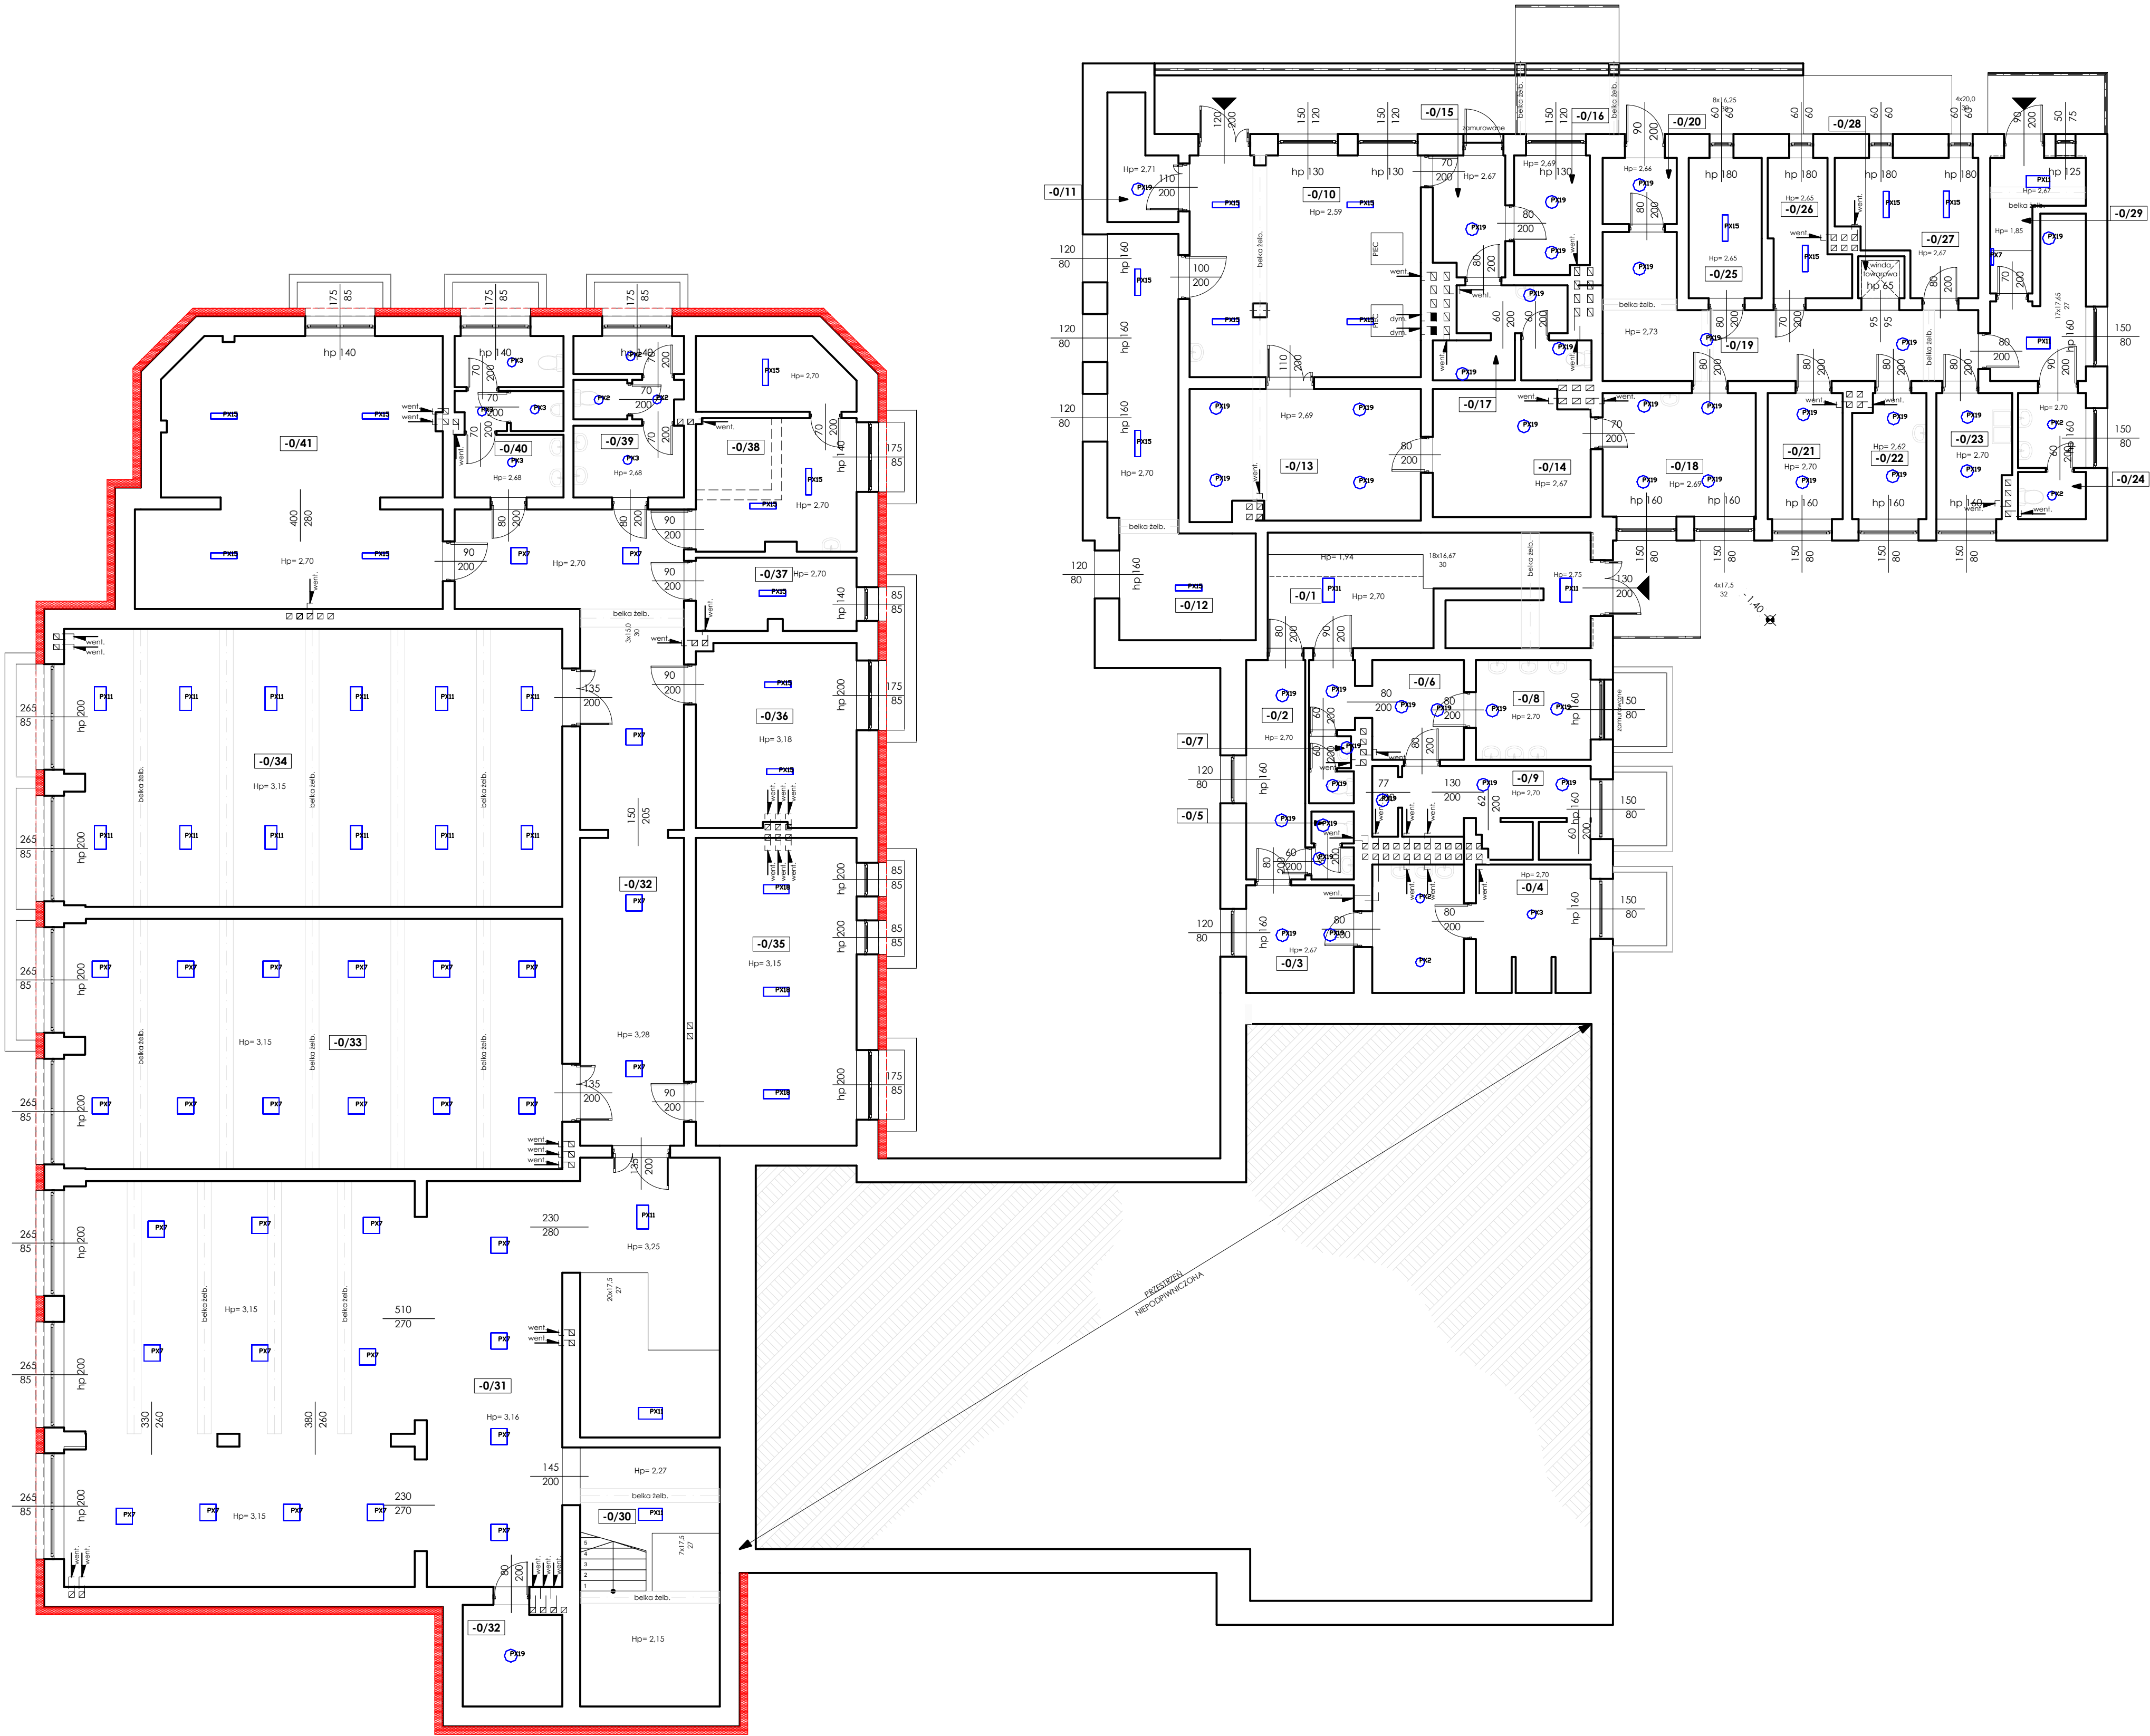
Instalacja oświetlenia – rzut parteru
